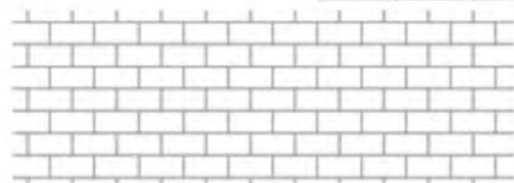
Propuesta de pavimento II. Autor: José Luis Tapia Ayala
